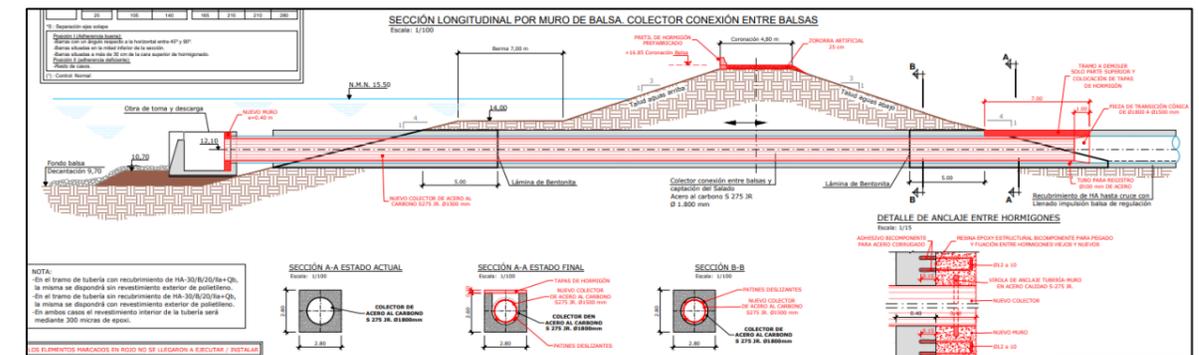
Sección longitudinal por muro de balsa colector de conexión entre balsas. Balsa Alcantarillas
